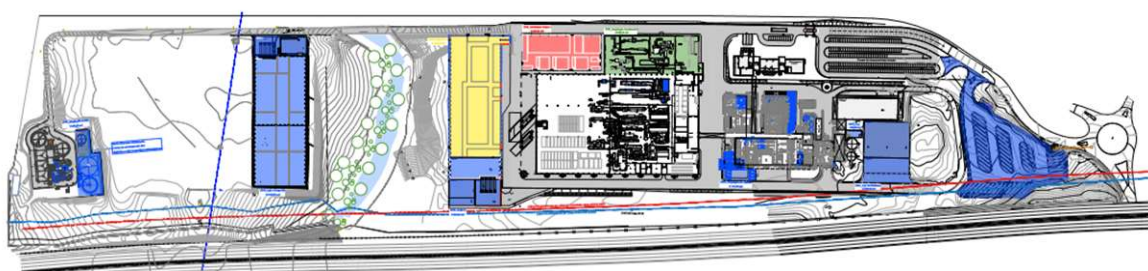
Planta com intervenções que constituem o projeto a azul.
